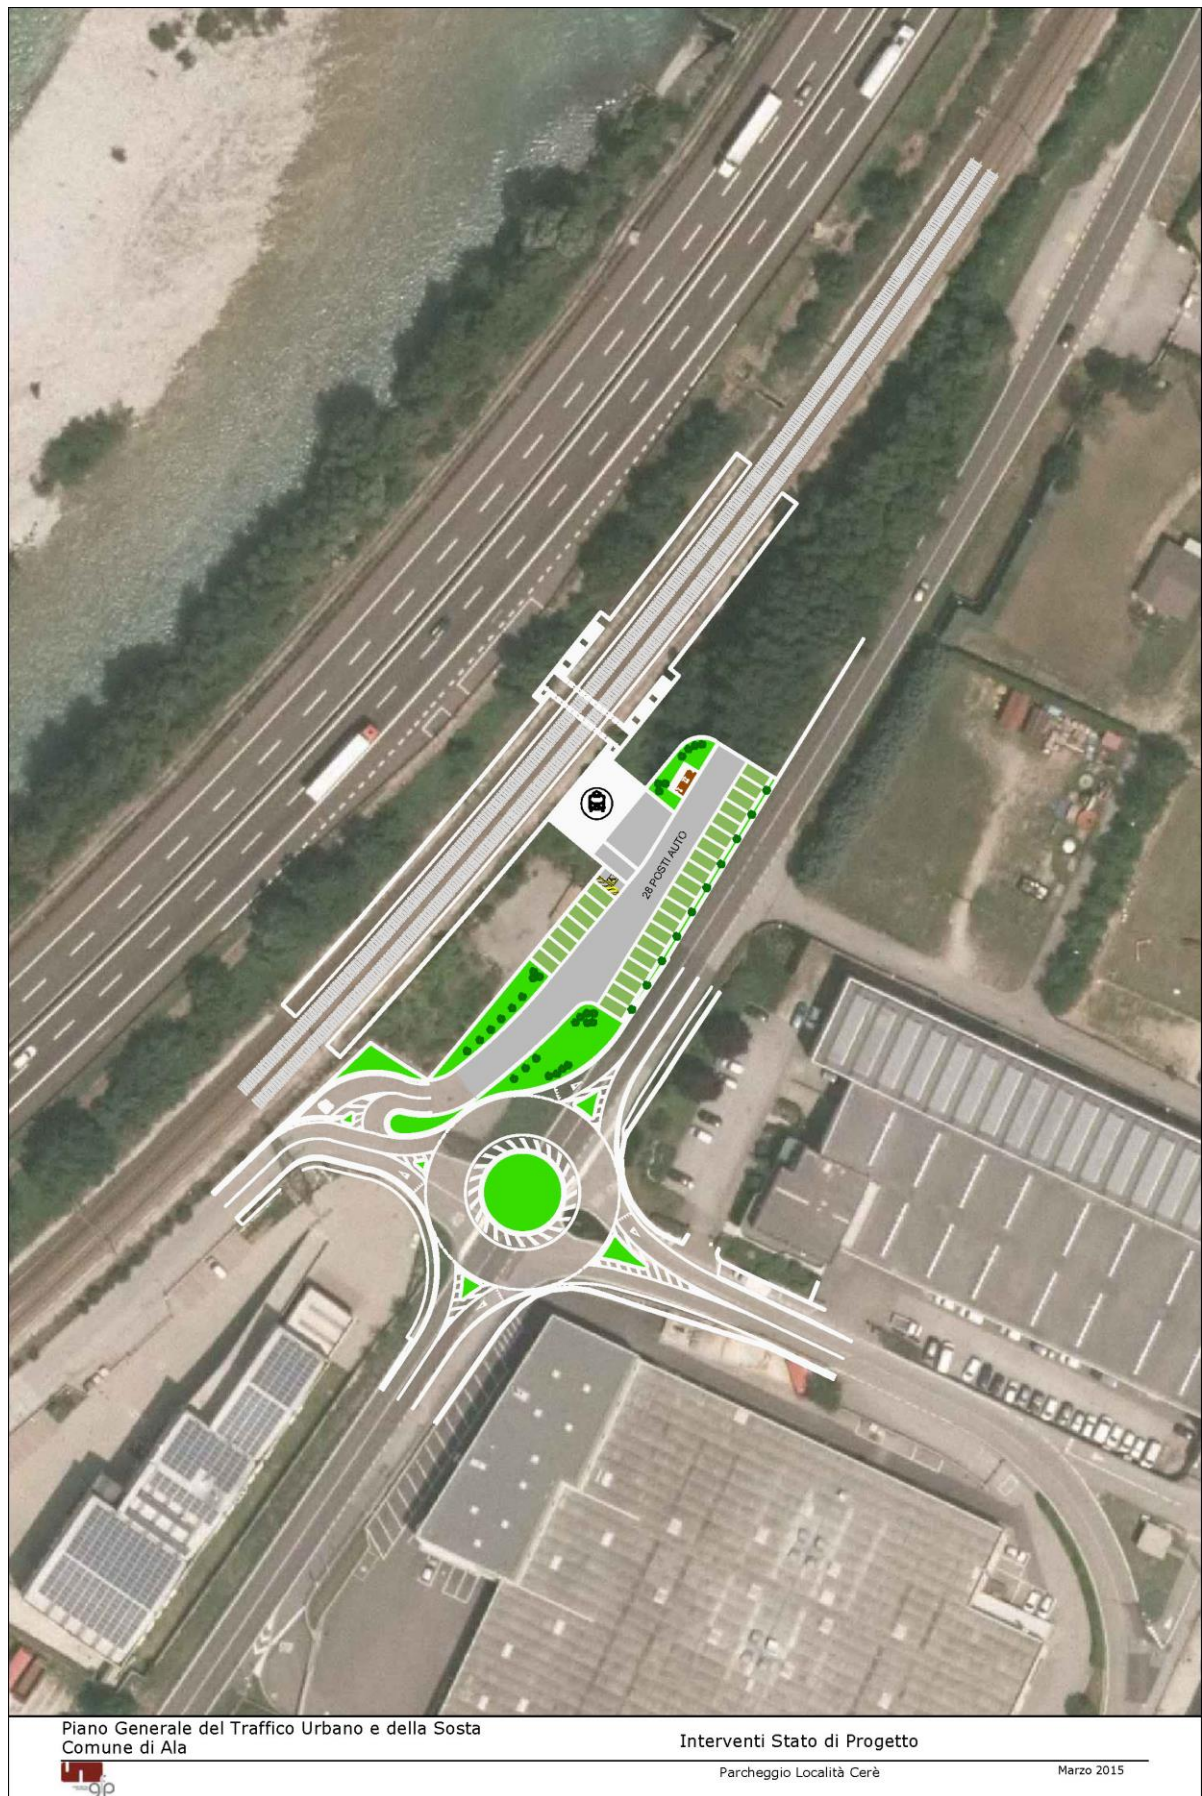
Interventi Stato di Progetto – Lungo Termine – Parcheggio fermata Località Cerè
